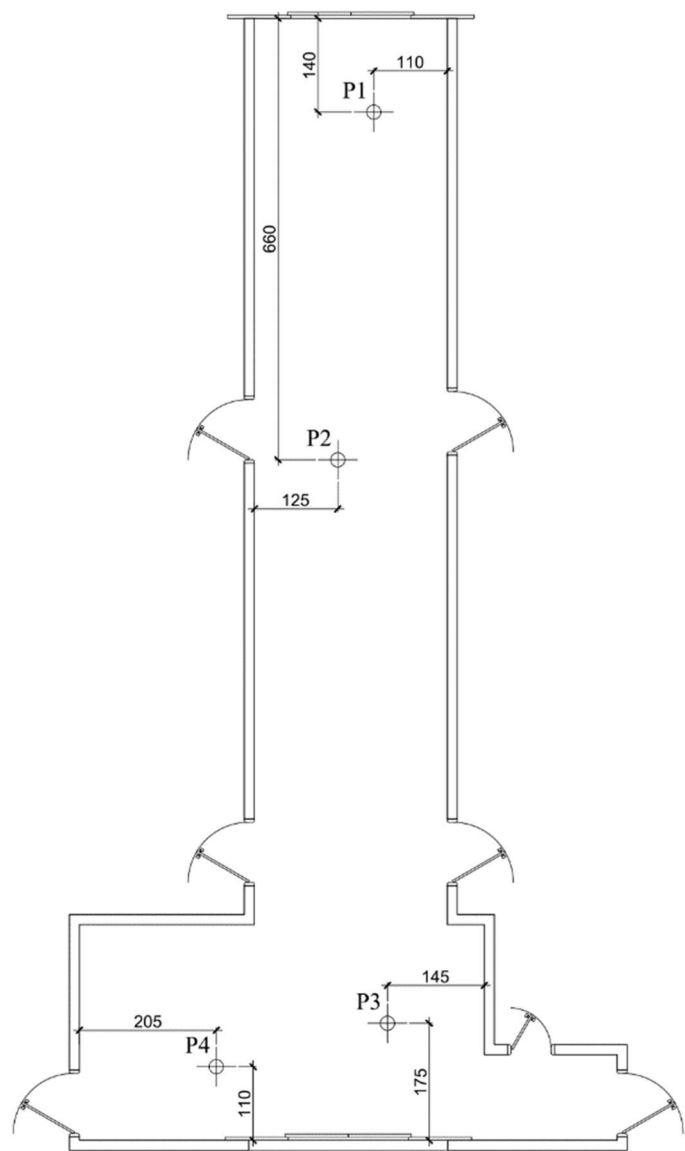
Localização de pontos – LAeq – Corredor do Pavimento Térreo
